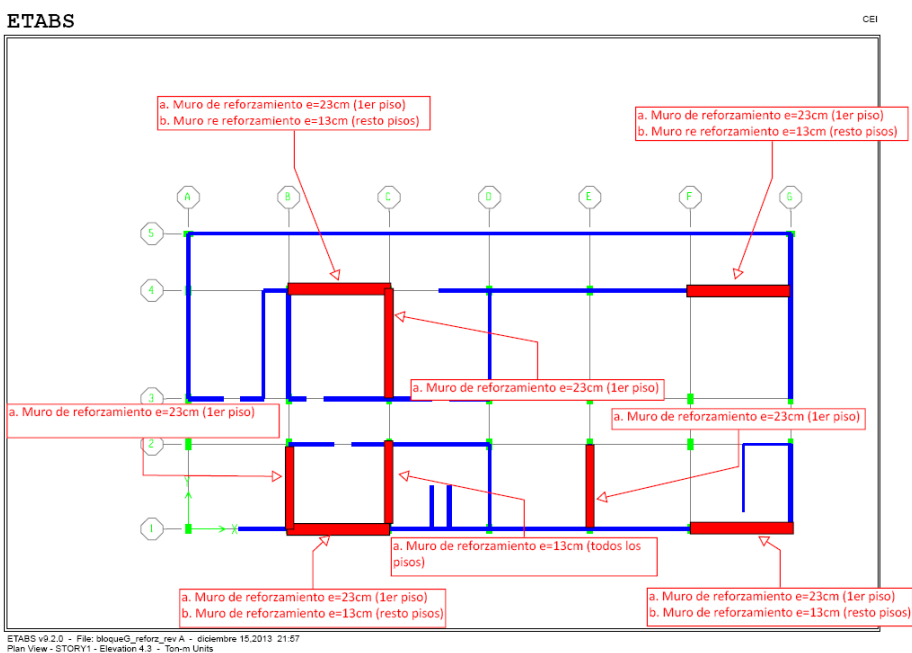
Esquema de reforzamiento con muro de concreto en bloque G
